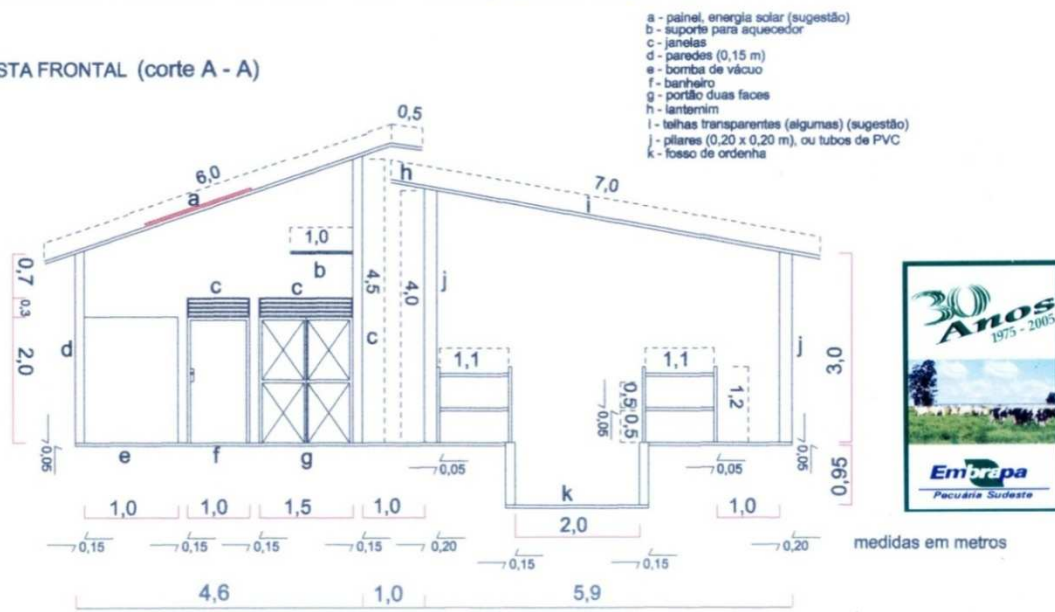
Vista de perfil. Planta da sala de ordenha - Embrapa Sudeste.
